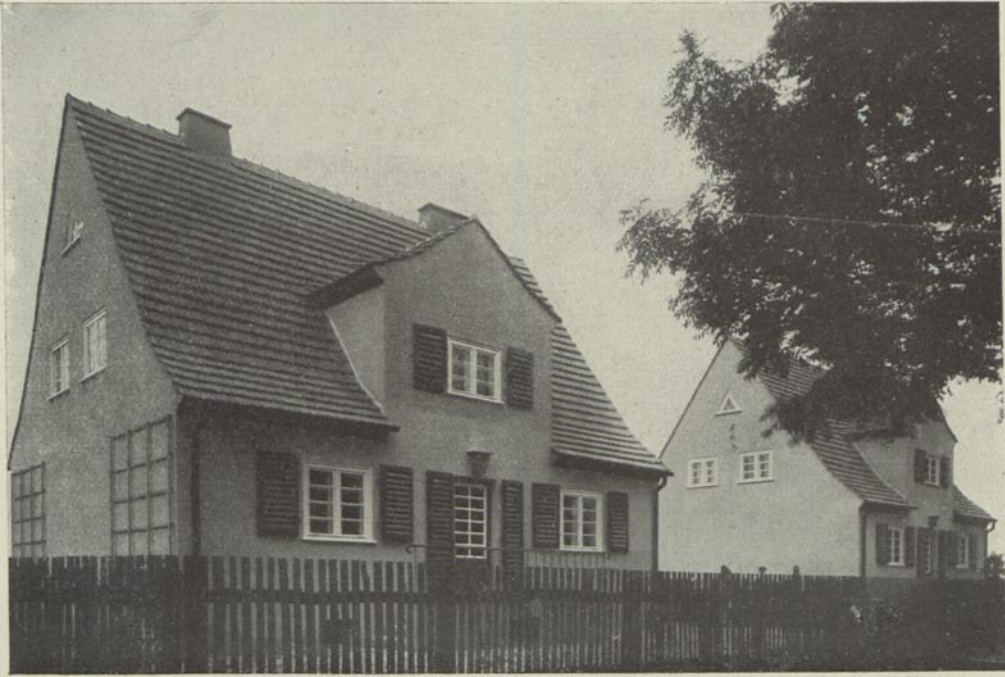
Aus einer Siedlung für abgebaute Beamte in Sczepanowitz.
